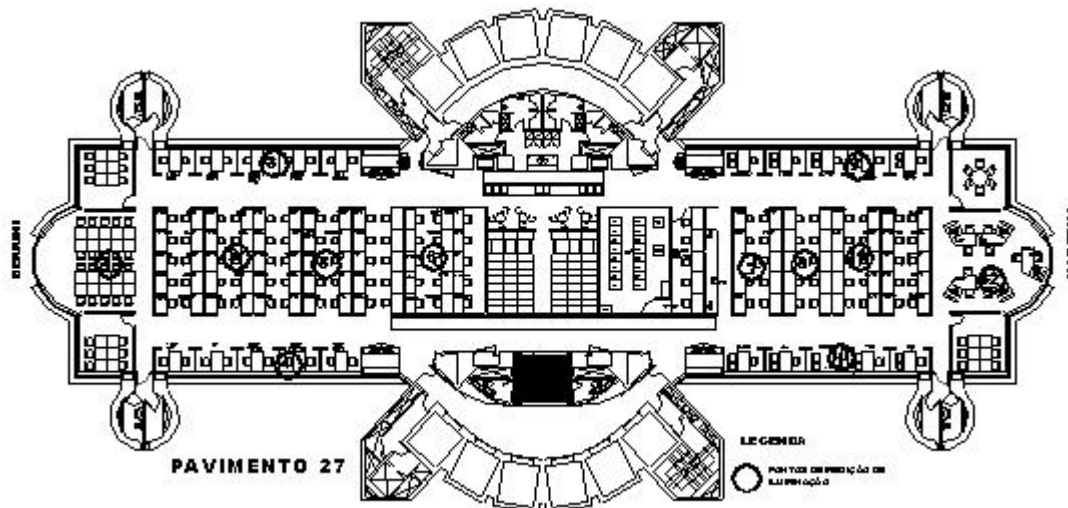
Planta Baixa 27.º Pavimento da Multibrás - Análise da Ocupação Física.
